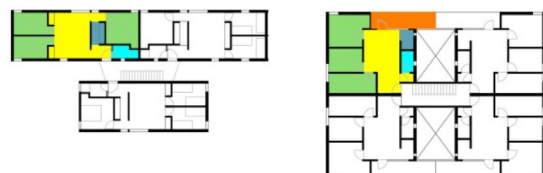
Planta de Tipos A (izquierda) y B (derecha). Fuente: Elaboración propia a partir de Hogar y Arquitectura, nº42, 1962)
